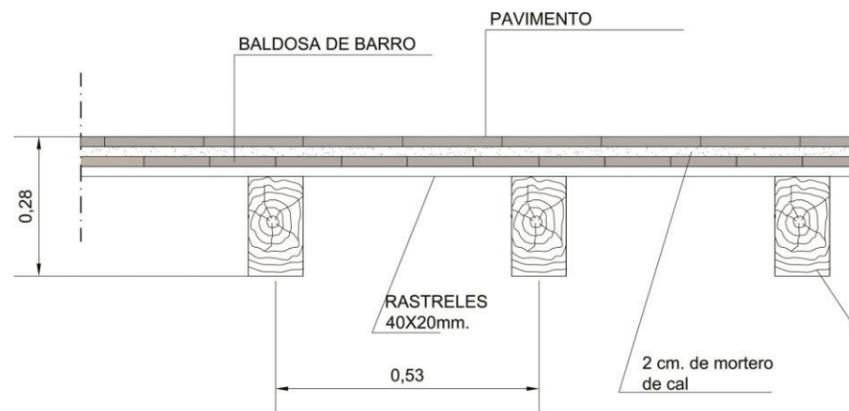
Detalle forjado Tipo 1. Fuente: Propia.
